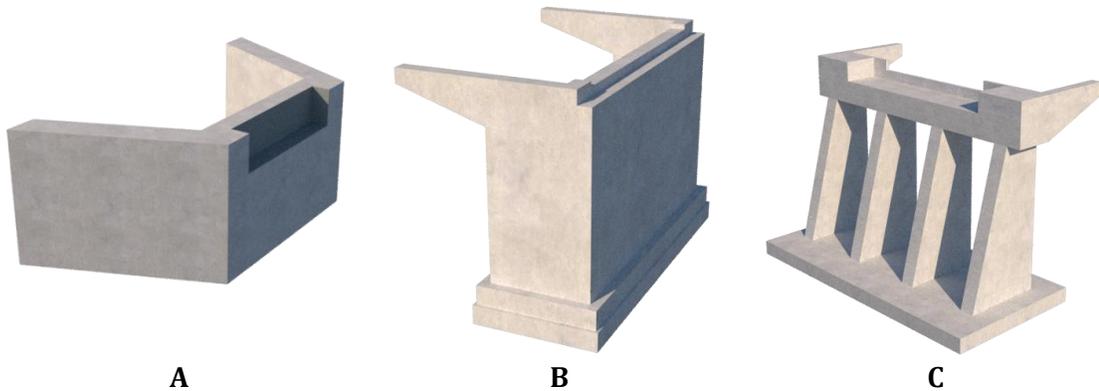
A- Estribo masivo o de gravedad, B- Estribo cerrado, aleros paralelos, C- Estribo abierto o falso estribo.
